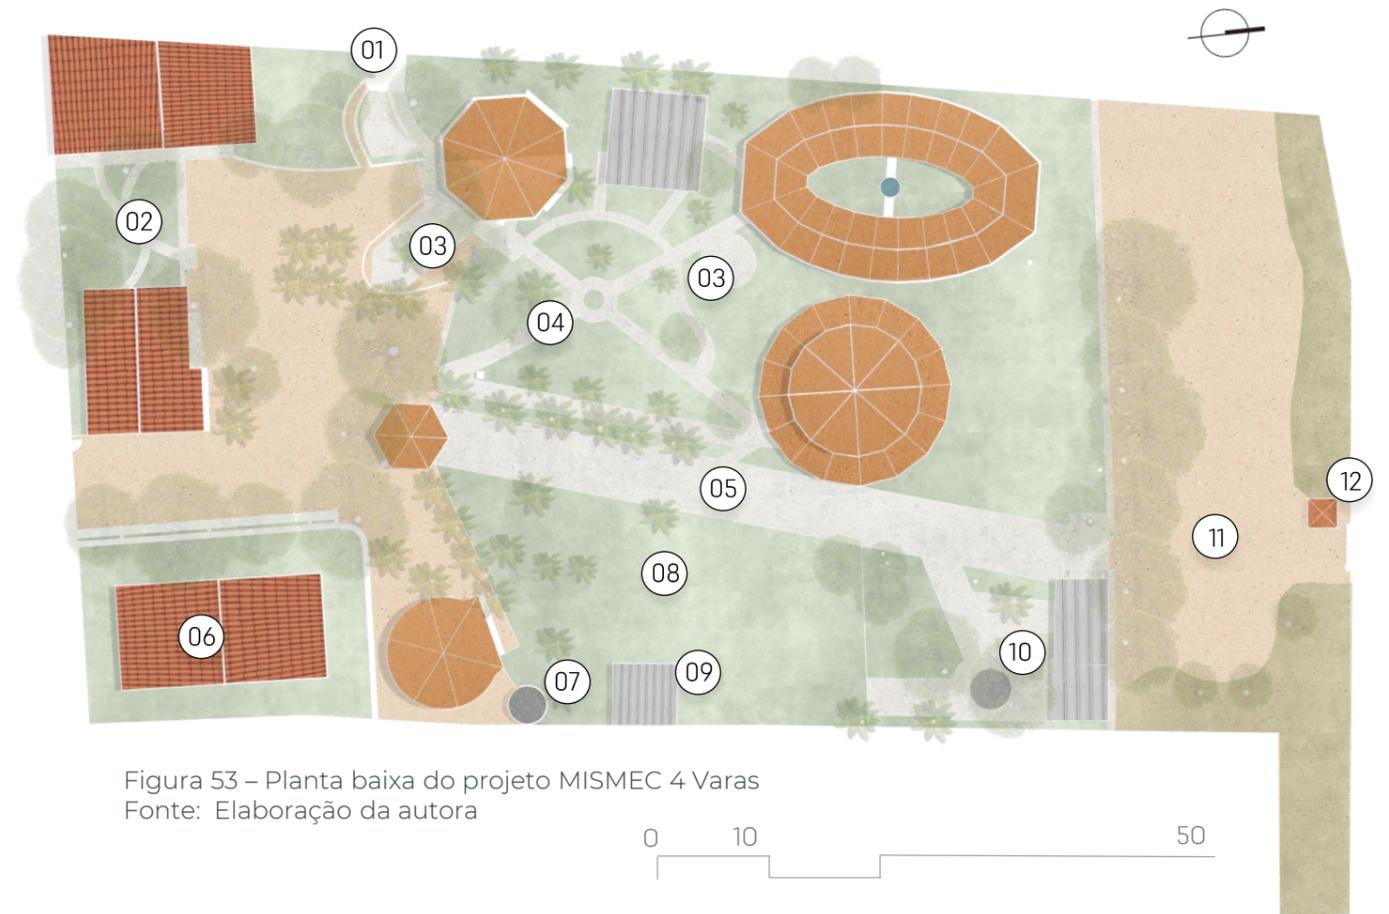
Planta baixa do projeto MISMEC 4 Varas
